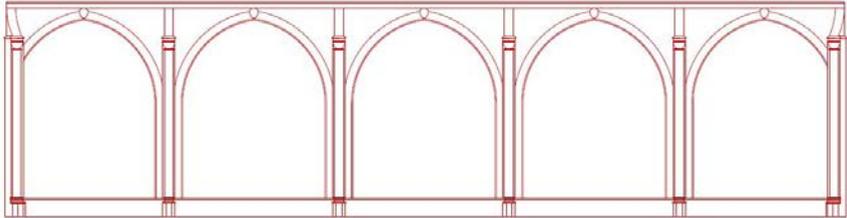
Alzado Norte del Claustro inferior. 2016. Plano del autor.
